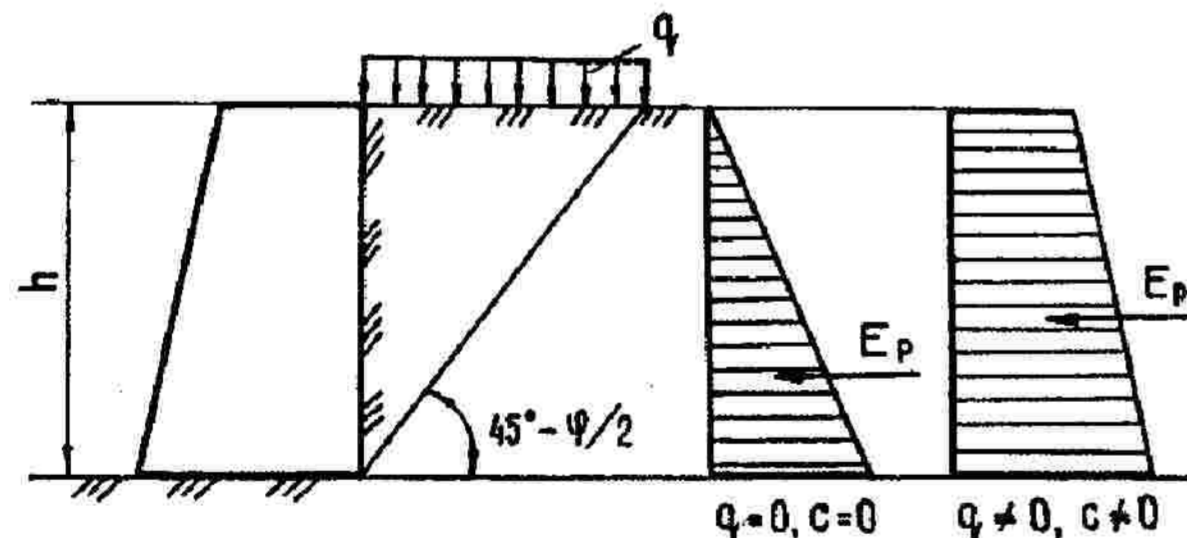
Схема к расчету пассивного давления грунта на вертикальную гладкую стенку
